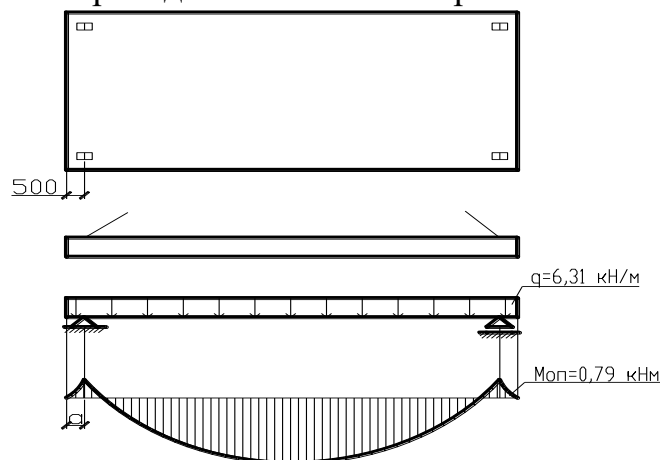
Розрахунок збірної залізобетонної круглопустотної плити перекриття на монтажні зусилля
